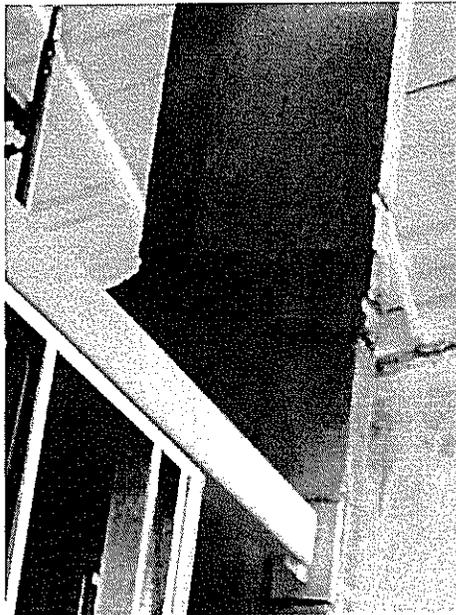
Pilar del eje D con eje 21, nidos evidentes bajo viga.
